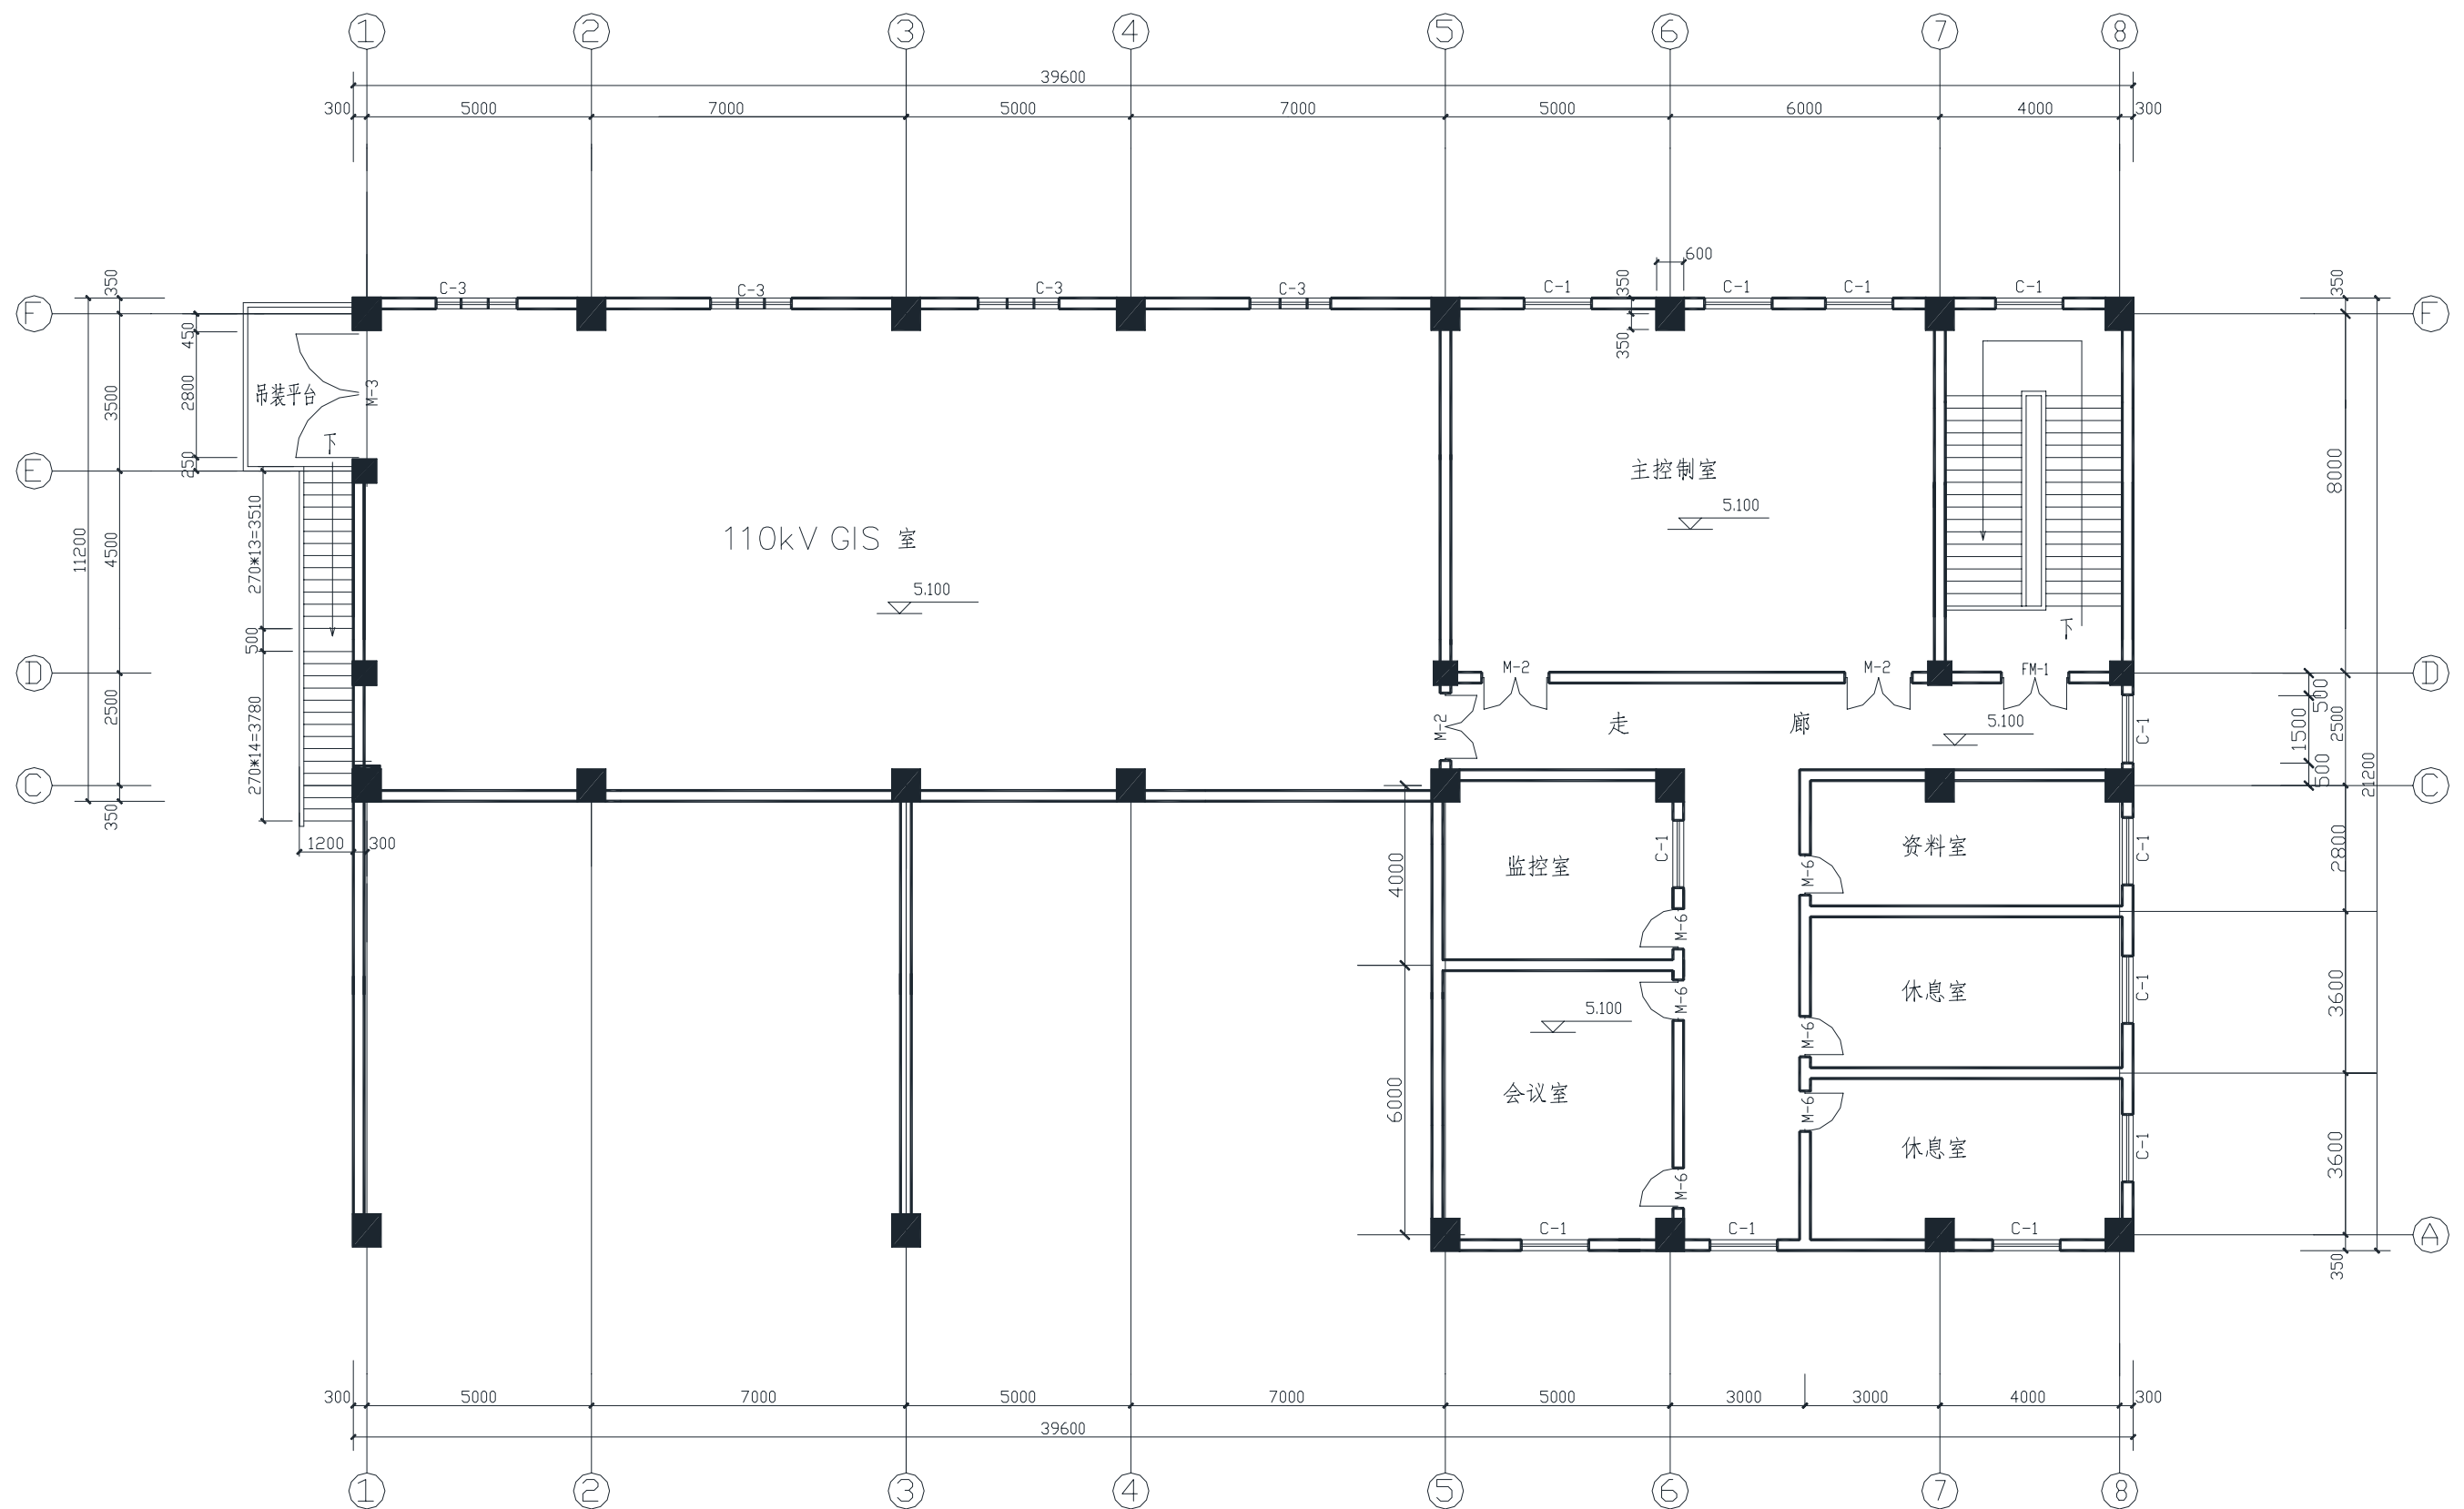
综合配电楼二层平面布置图(A3-2-06)
